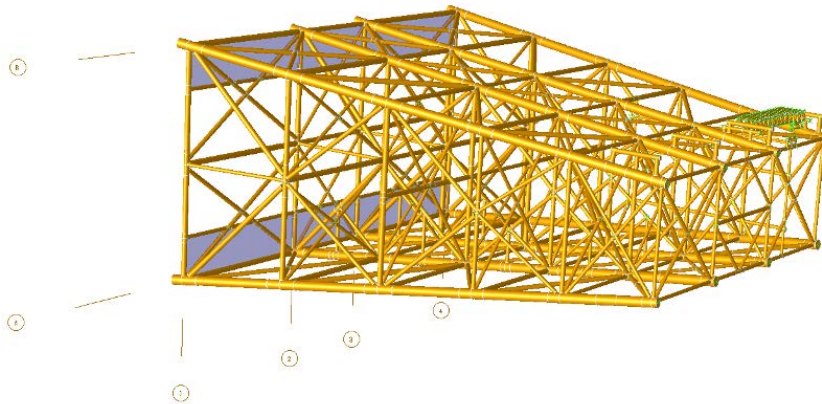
Ejemplo de un modelo estructural de una subestructura.
